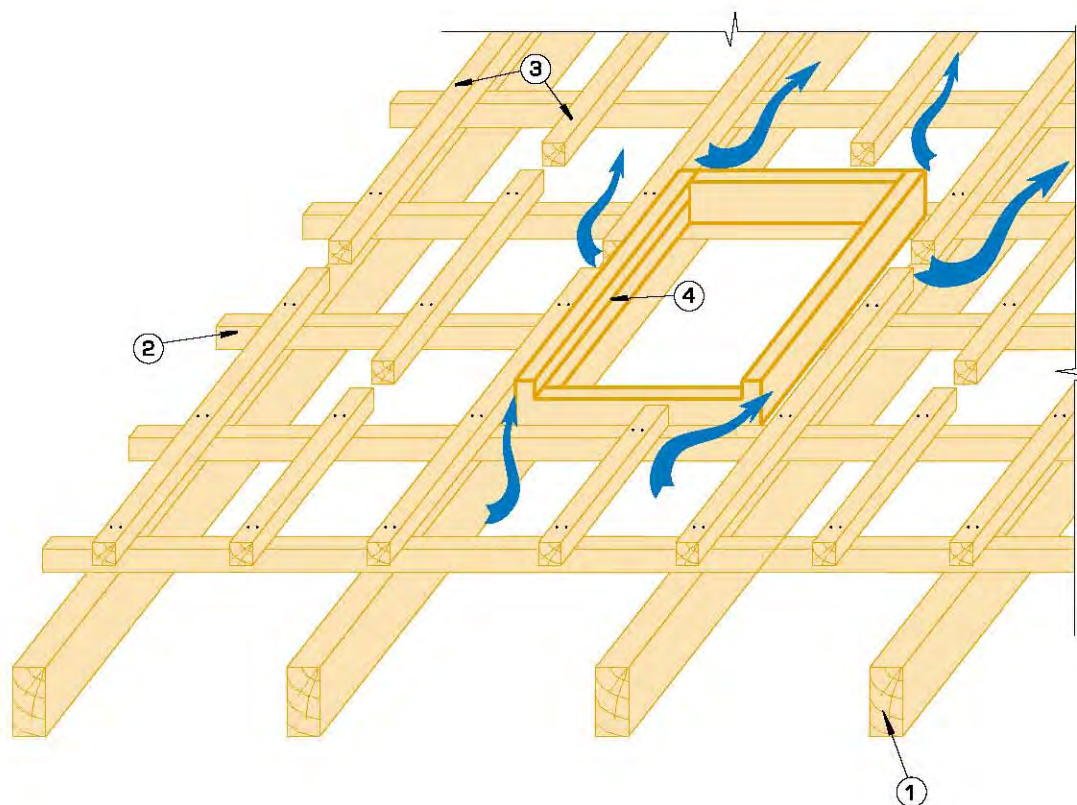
Вариант примыкания кровли «жилой мансарды» к дымовой трубе
